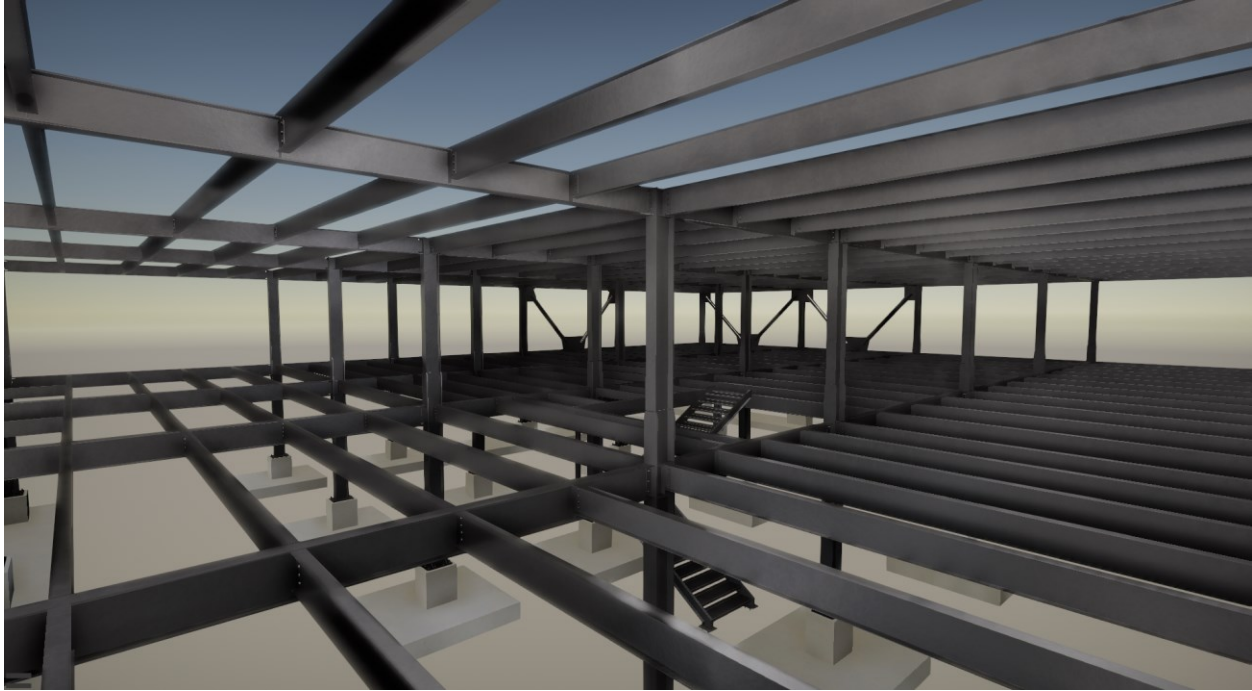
Modelo BIM. Vista entrepiso Proyecto de Oficina
